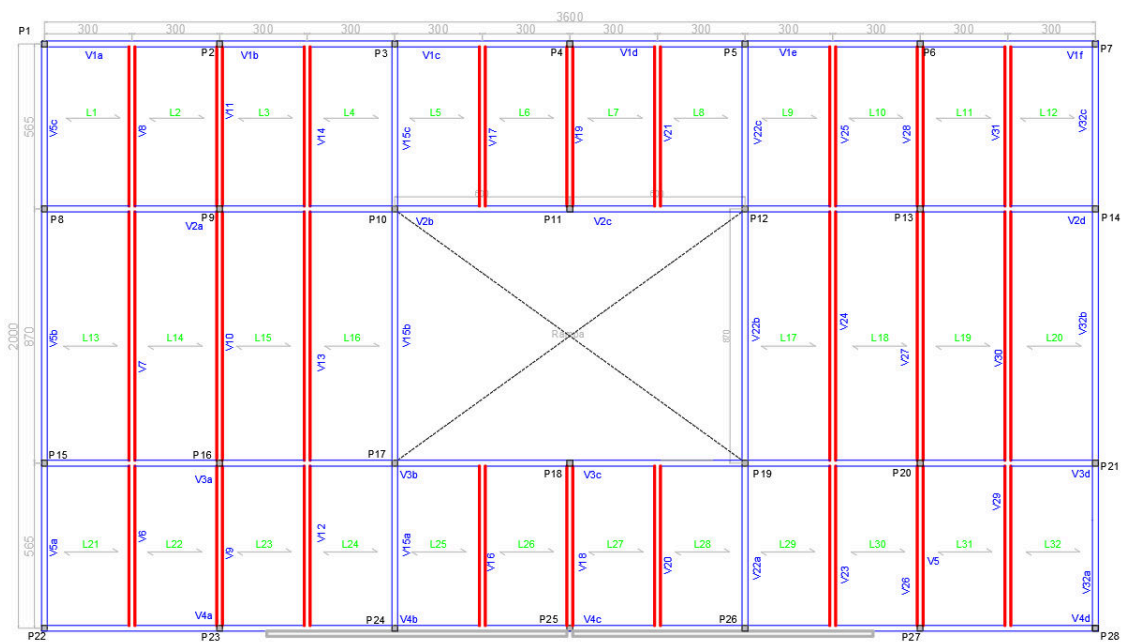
Planta de Forma do 1º pavimento tipo, nível +3,00 m.
